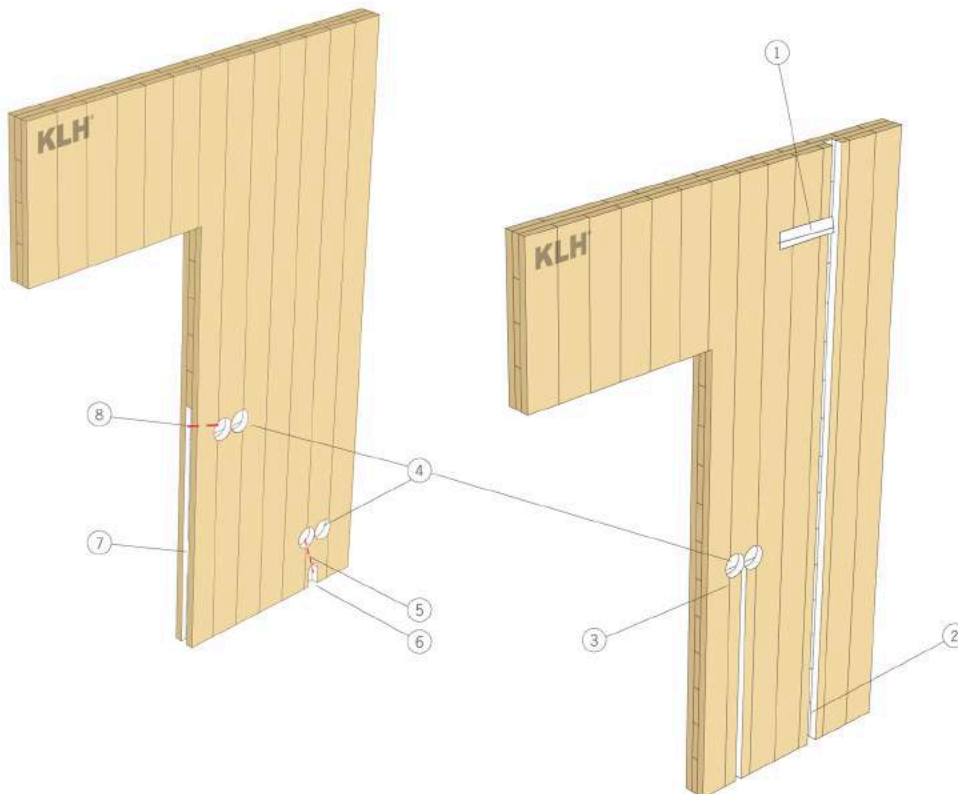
Detalhe construtivo da ligação transversal entre painéis do mesmo plano
